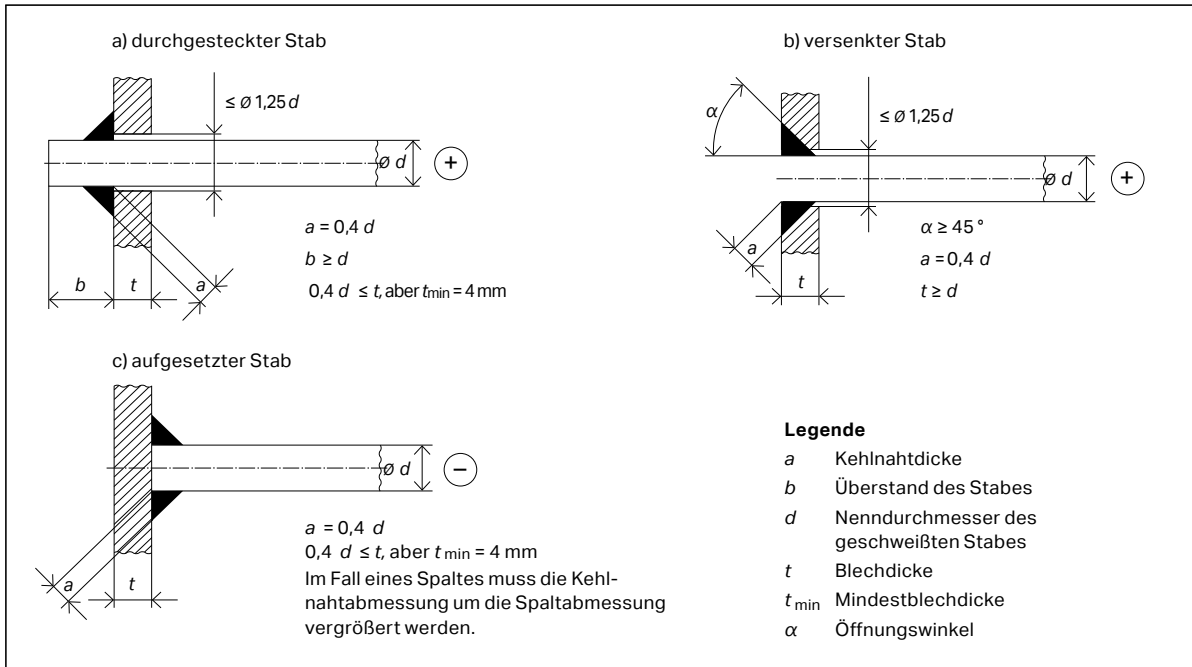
Geschweißte Stirnplattennähte nach Kap. 6.6.2.2 – Bild 9
